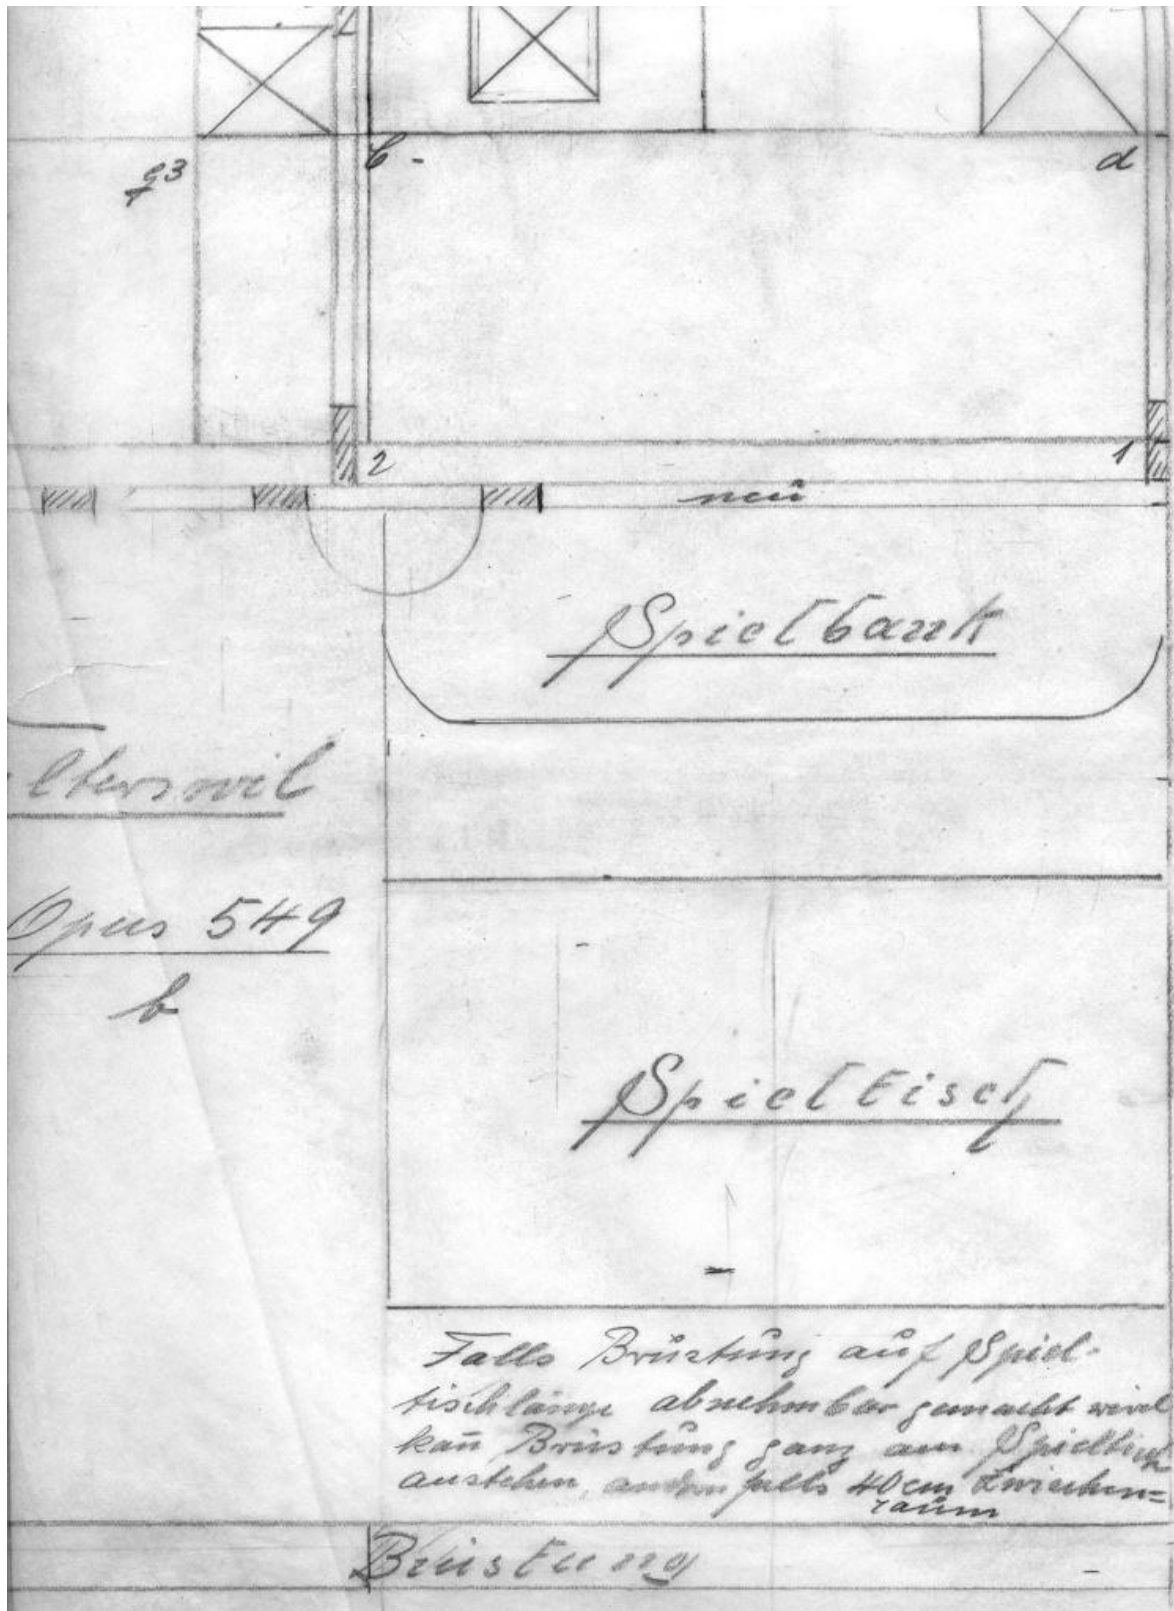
Ausschnitt aus der Grundrisszeichnung der Orgel der reformierten Kirche Walterswil BE (Opus 549, 1924) von August Hartmann (Archiv Orgelbau Goll, Mappe Walterswil).
